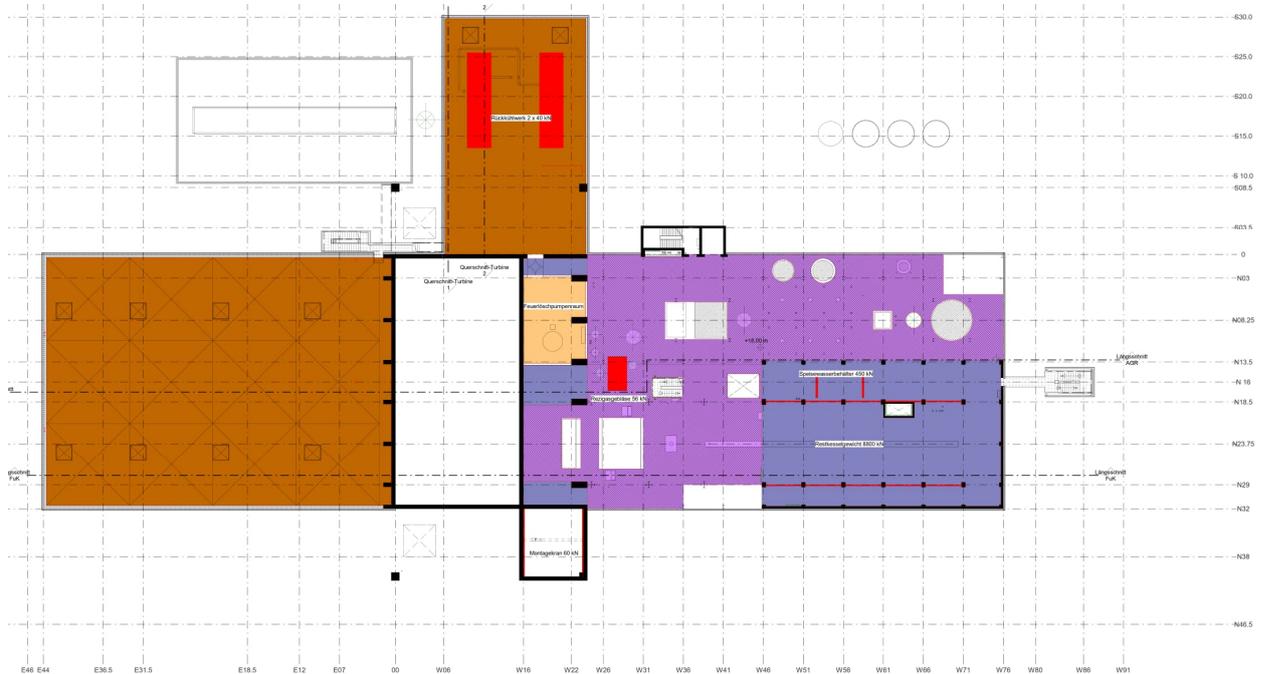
Nutzlasten Grundriss +18.00m
